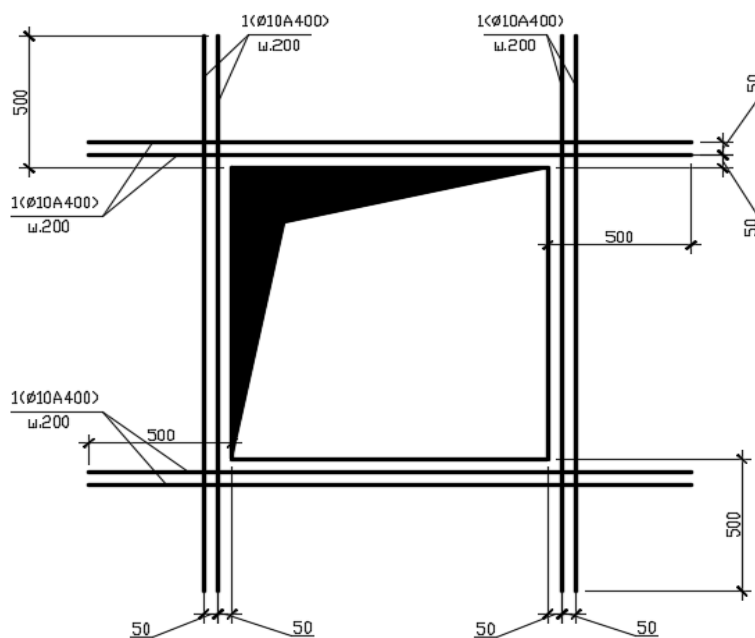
Фрагмент армирования отверстий перекрытия
